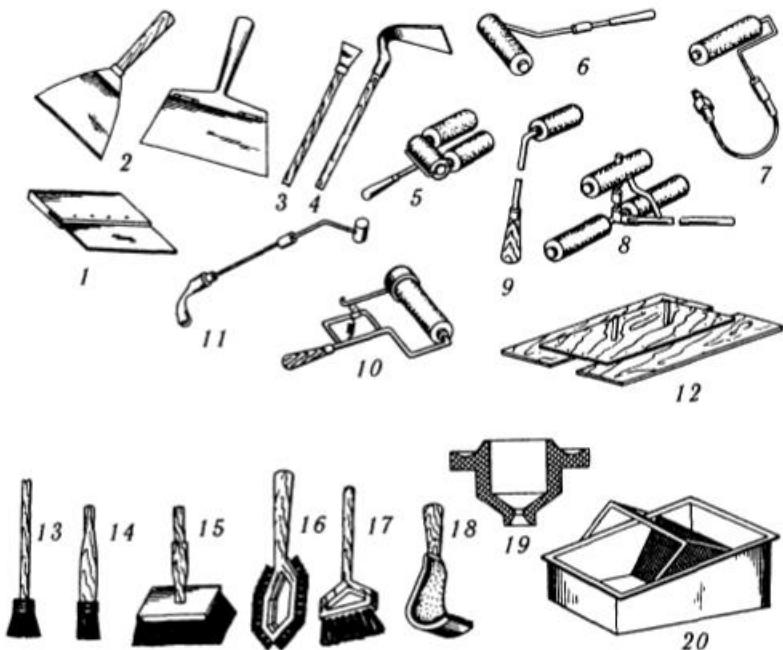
Ручні інструменти та пристрой для малярних робіт:
